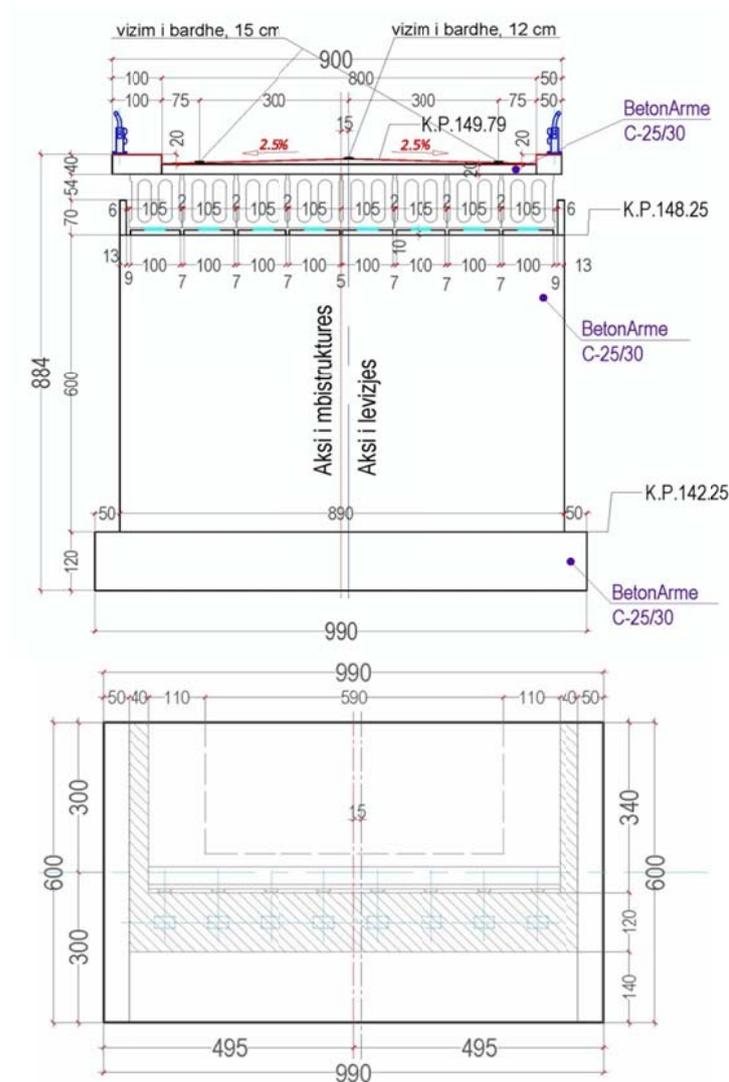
Prerja tërthore e ballit dhe planimetria e themelit të poshtëm të ballit 1 dhe 2
